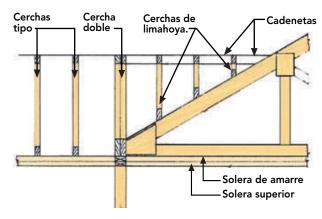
Elevación que muestra cadenetas entre cerchas.
